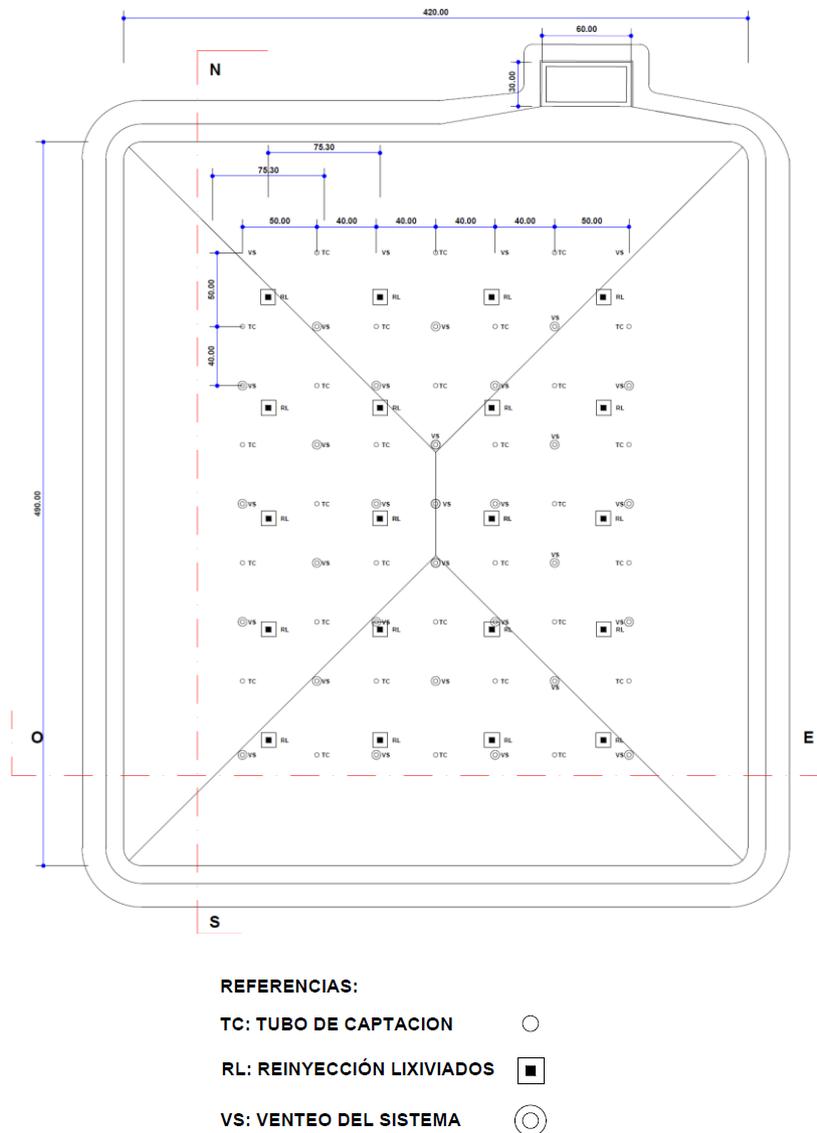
Esquema de Planta Sistema de Reinyección de lixiviados
